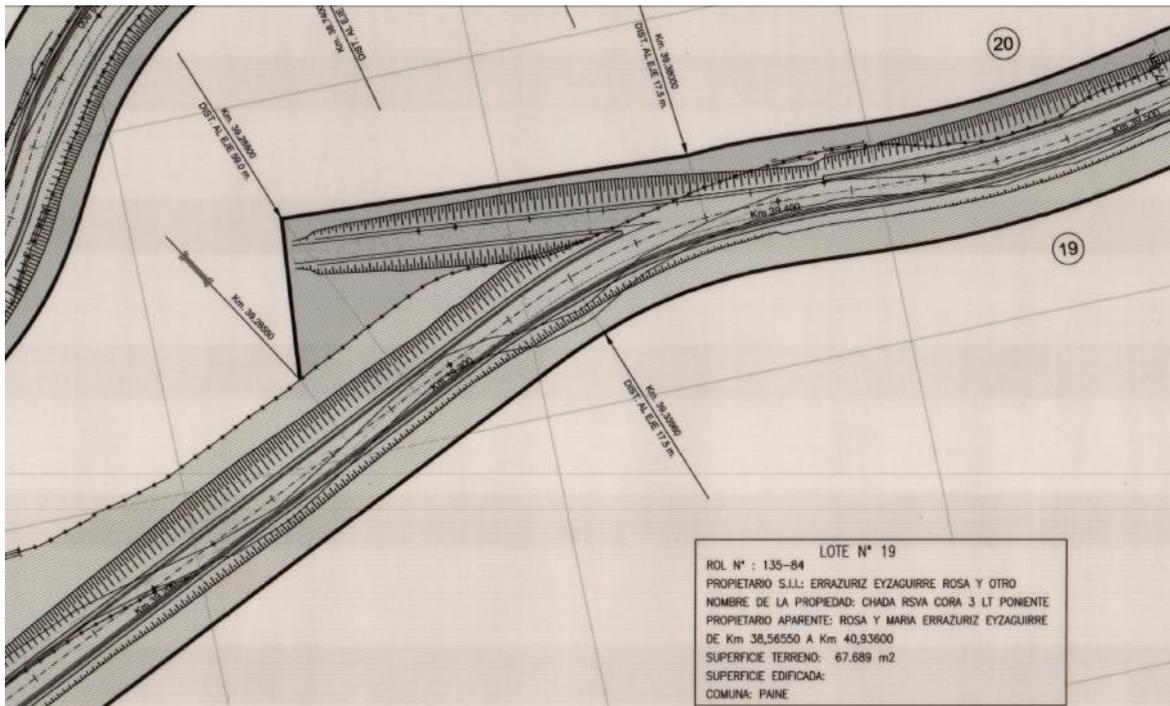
Extracto del "Plano de Expropiaciones - Plano E - Lamina 04 de 05". Se muestra el sector donde se instalará el polvorín, el que después se construirá la rampa de emergencia. Ver plano completo en el Anexo C.
